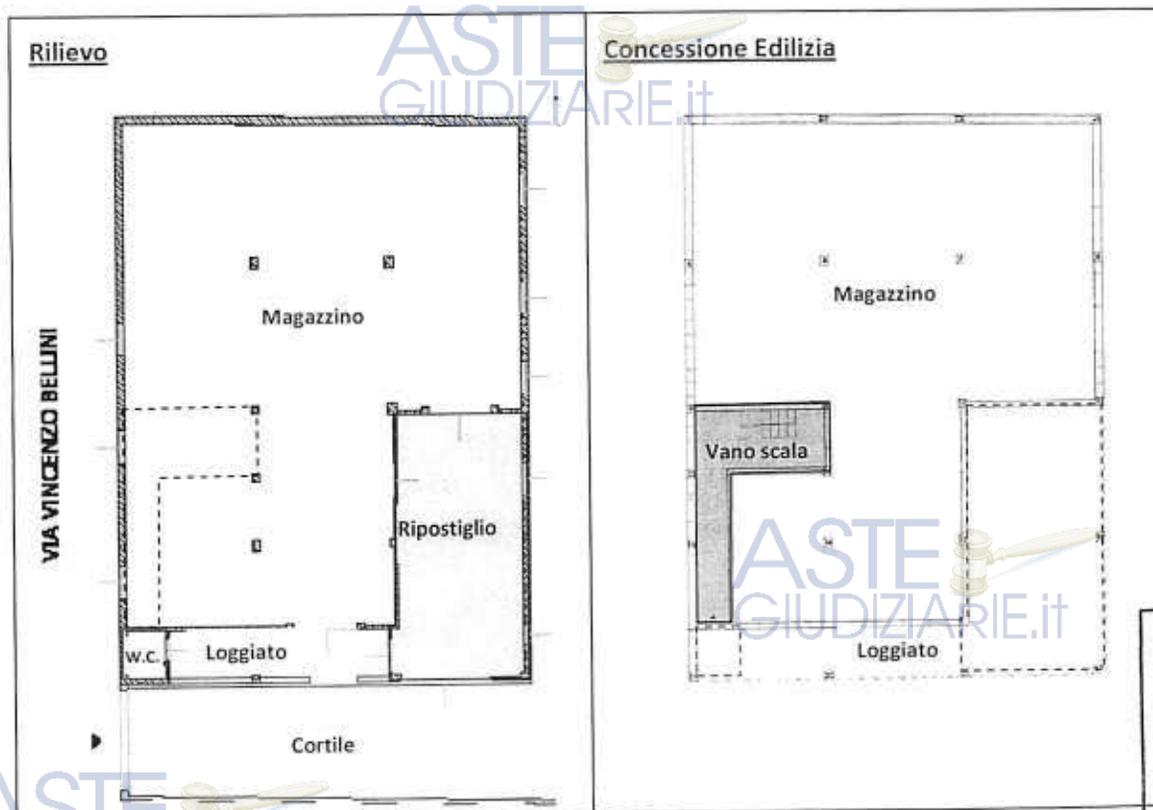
Planimetria dello stato attuale dell'immobile, evidenziate con linea tratteggiata i vani mancanti rispetto alla
